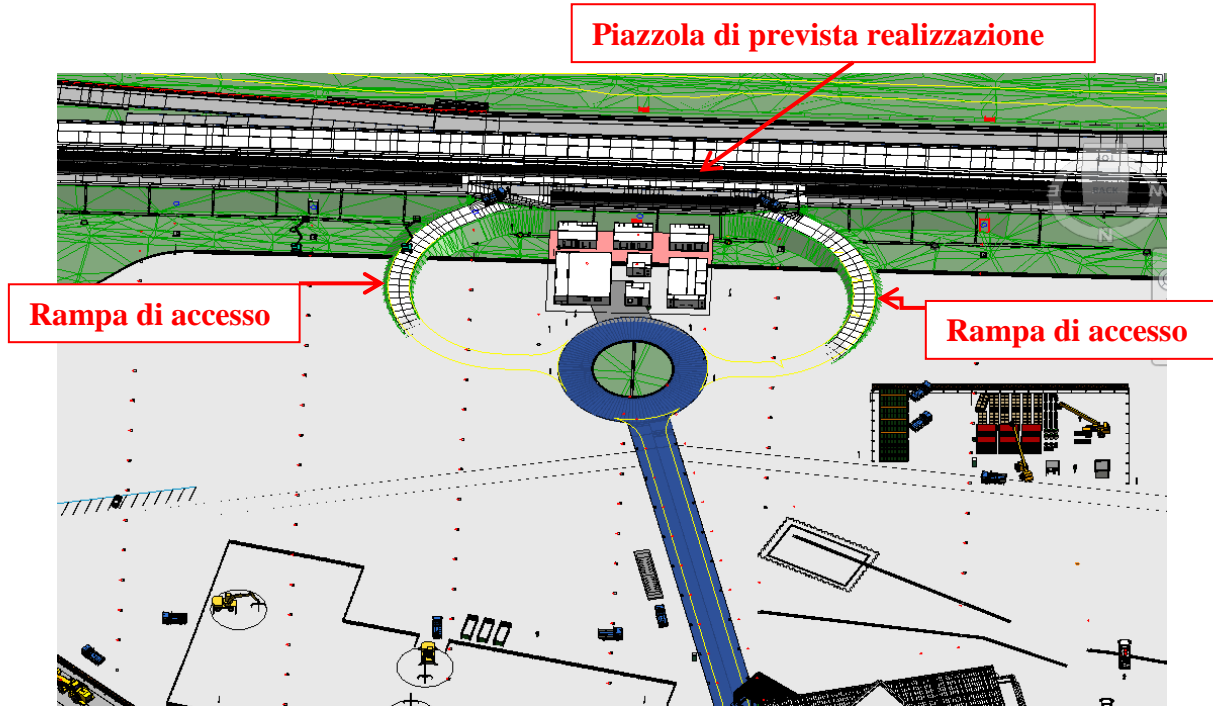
Vista del varco temporaneo e delle rampe di accesso all'area di lavoro
